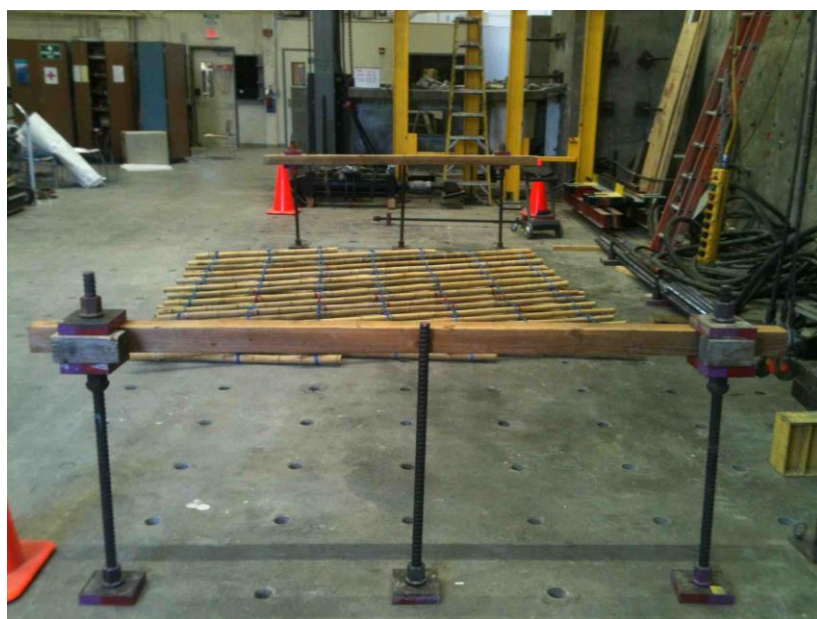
Colocação da barra horizontal de madeira, fixada em barras metálicas para estabilizar a base do arco.
